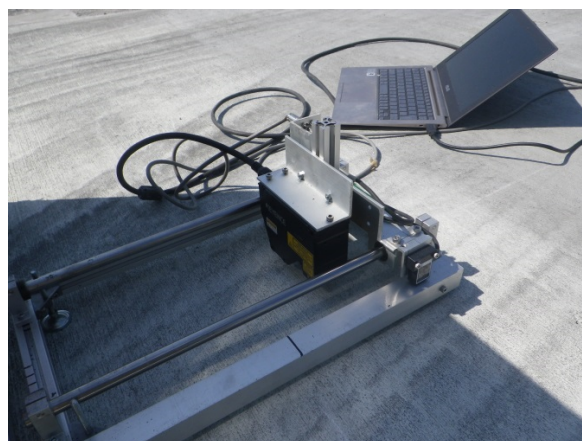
ラインレーザ変位計による路面テクスチャの測定状況
